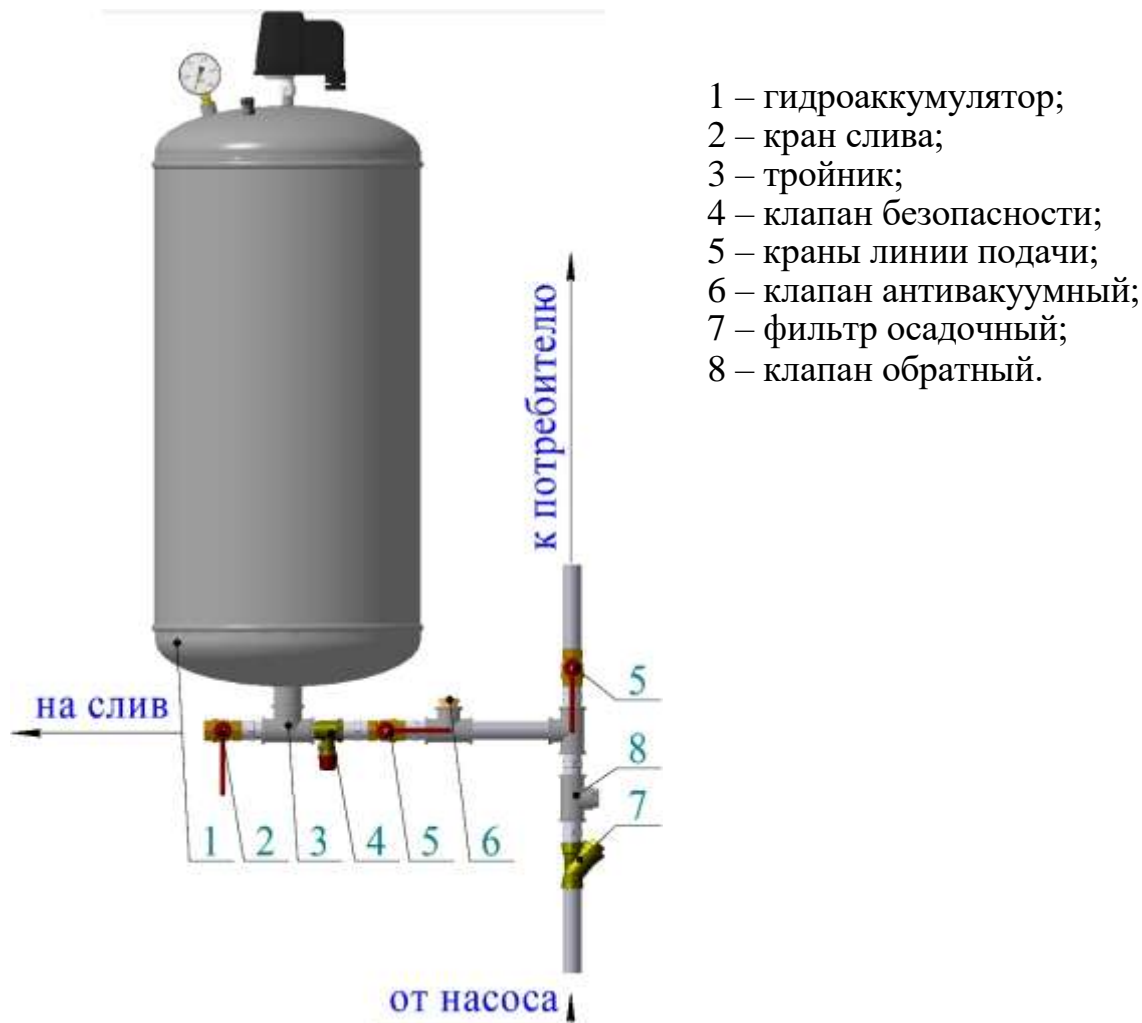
Условная схема подключения гидроаккумулятора к водопроводным сетям жилого дома
